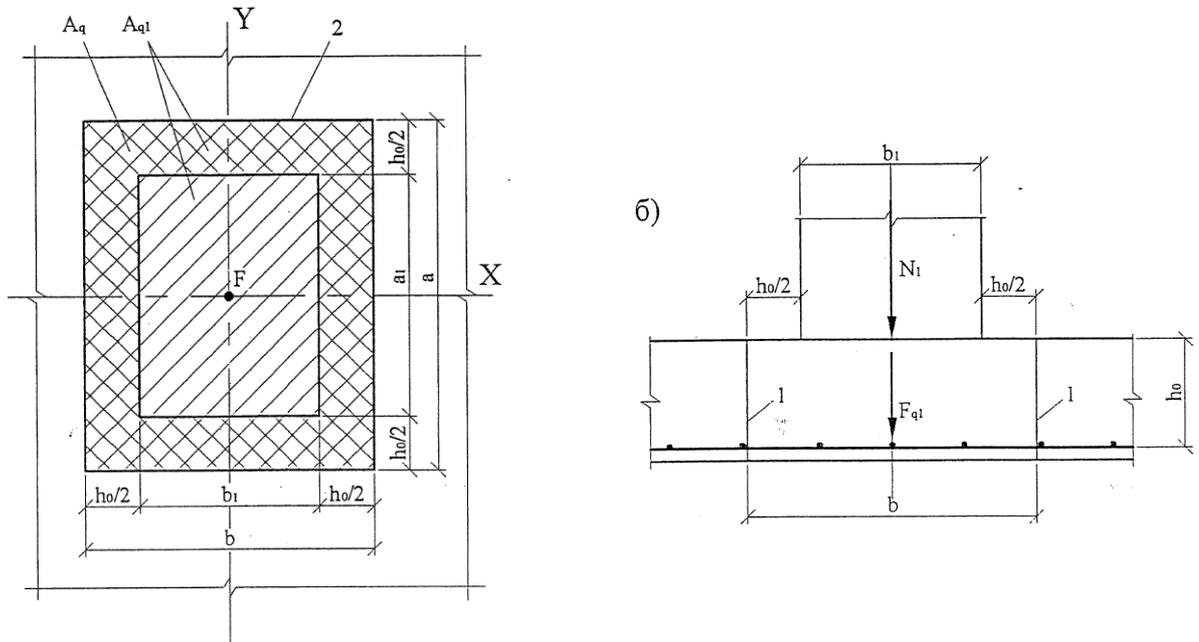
Расчетная схема железобетонной плиты на продавливание
